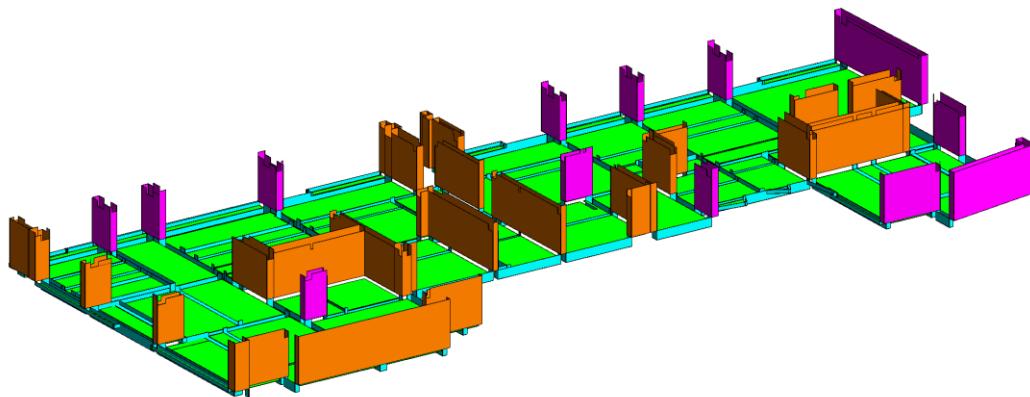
Automatización del modelado encofrado columnas, vigas, losas, muros
